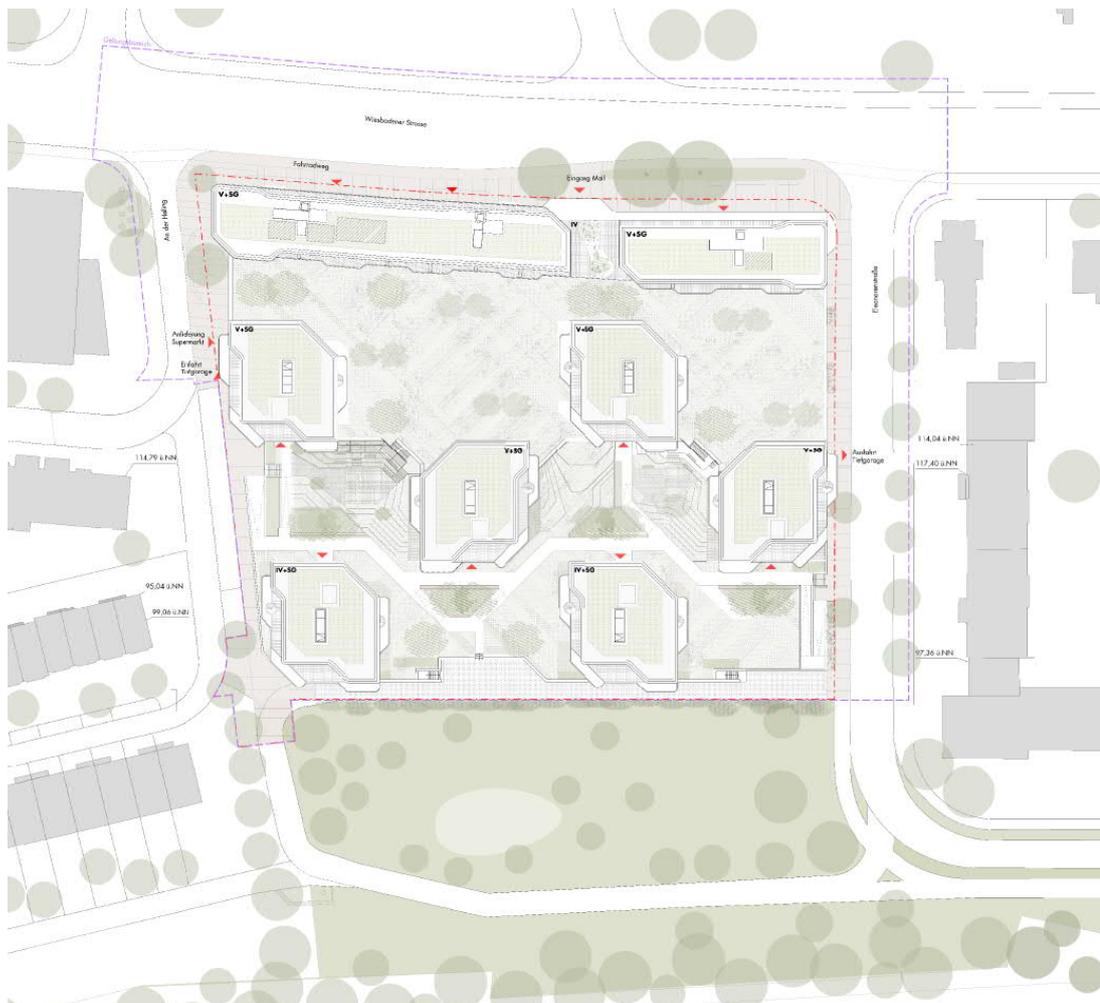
Lageplan - Entwurf (Quelle: Schneider + Schumacher Städtebau GmbH, Planstand 30.04.2021)
